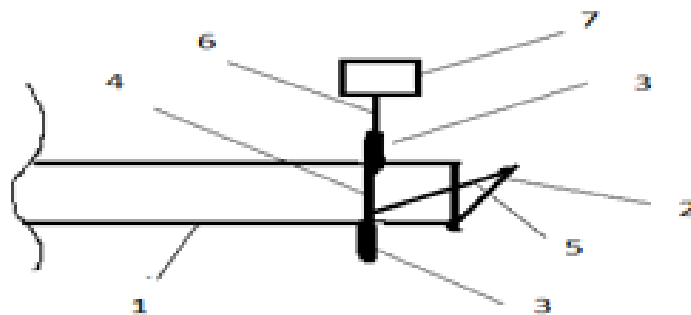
1. Труба водовыпуска; 2. Запорная крышка водовыпуска; 3. направляющие верхняя и нижние трубки; 4. рабочий шток поплавка в виде трубки; 5. гибкий трос соединенный с рабочим штоком поплавка; 6. верхняя часть рабочего штока поплавка из металла или пластмассы; 7. поплавок.
